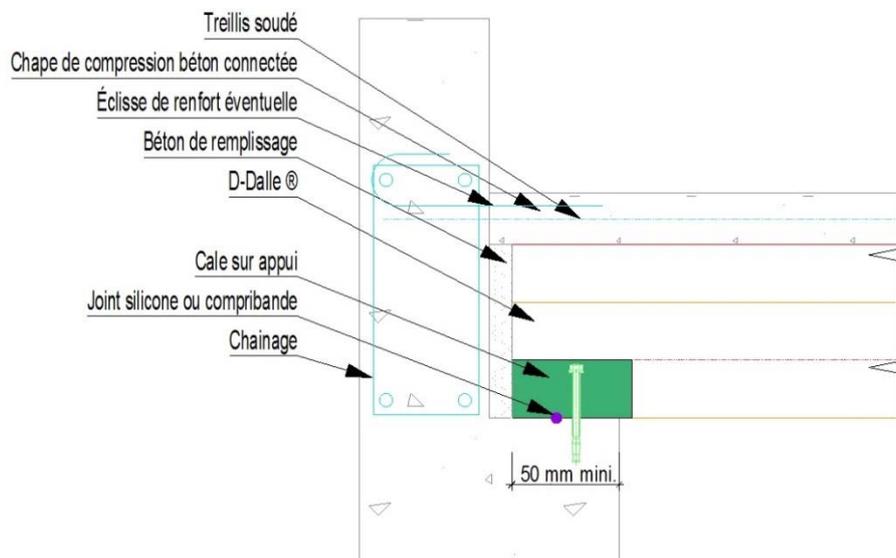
Coupe longitudinale – détail d'appui sur murs maçonné - béton
